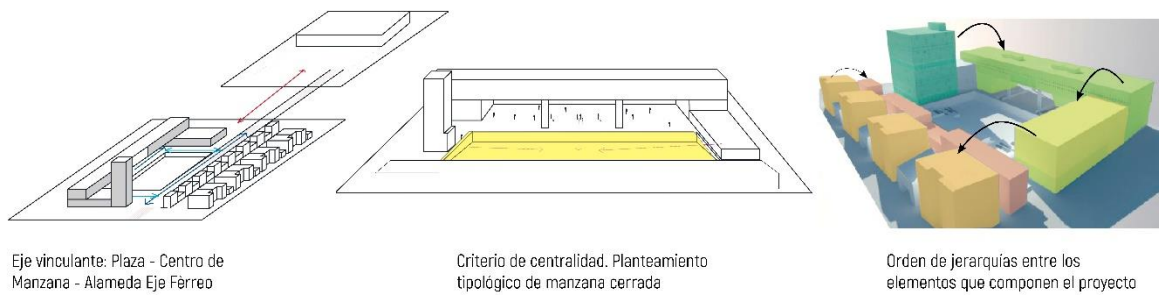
Conceptos de diseño usados para la concepción de la propuesta. *Fuente:* Elaboración propia. 2018. CC BY.
